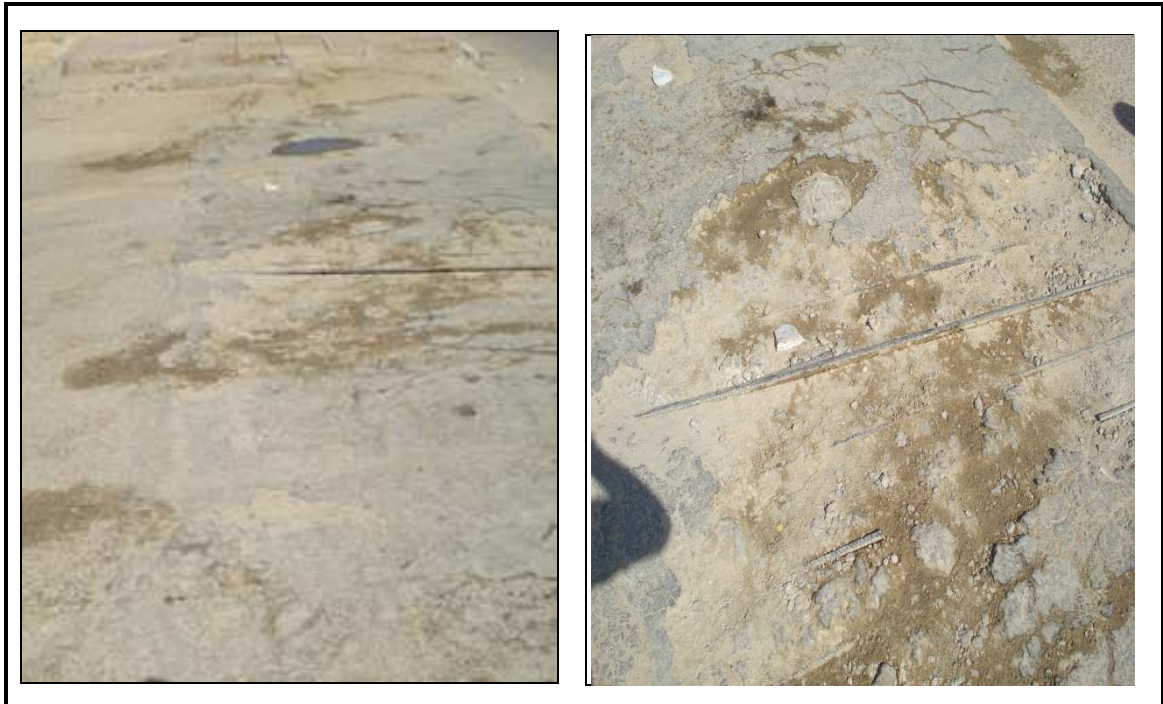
Détérioration apparente de la partie supérieure de la dalle de la galerie au niveau de la traversée de route par apparition de fissures.
